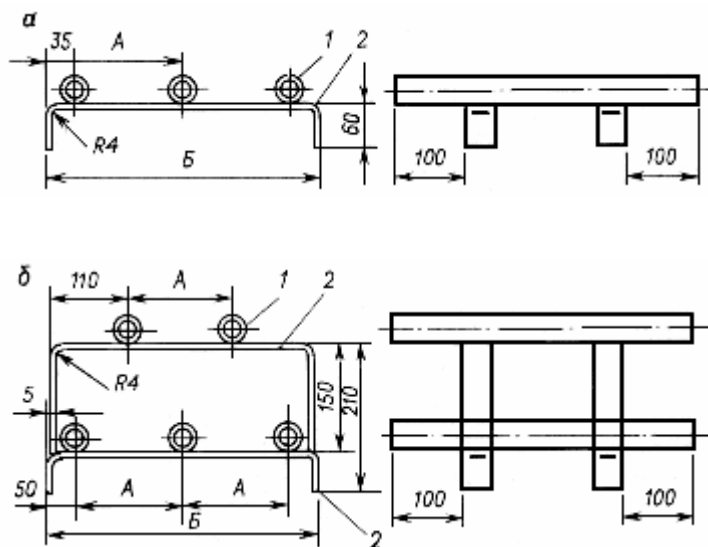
Рама с отрезками труб для прохода до пяти кабелей сквозь стены помещений со взрывоопасными зонами всех классов:
